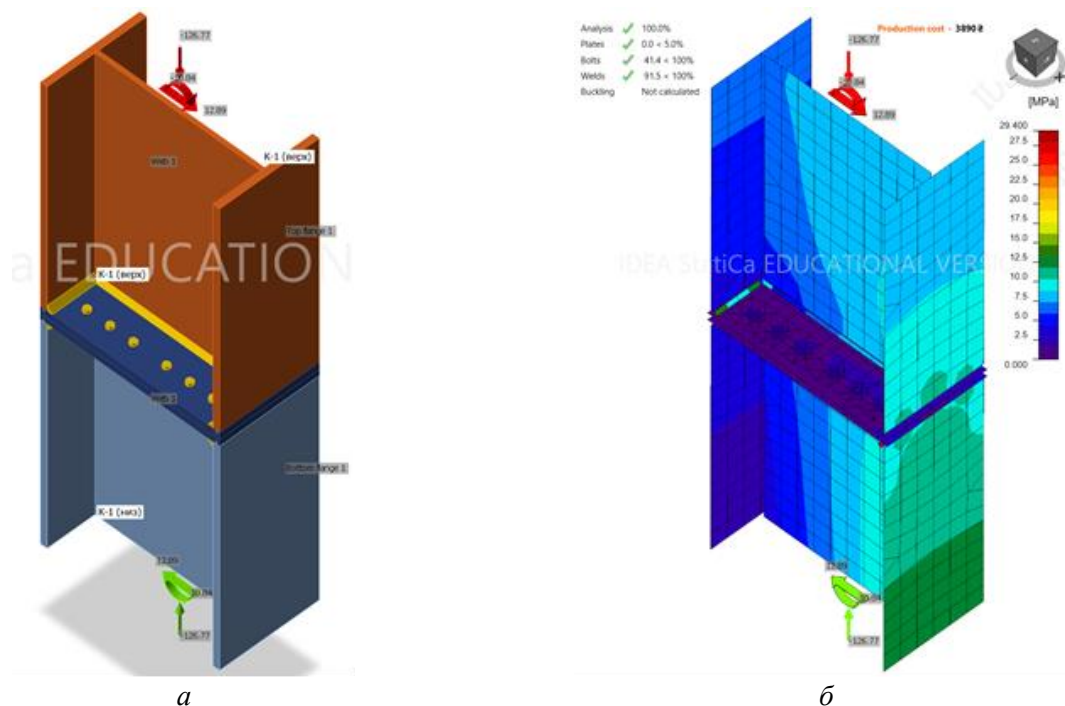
Монтажний вузол колони: а – модель; б – НДС вузла
